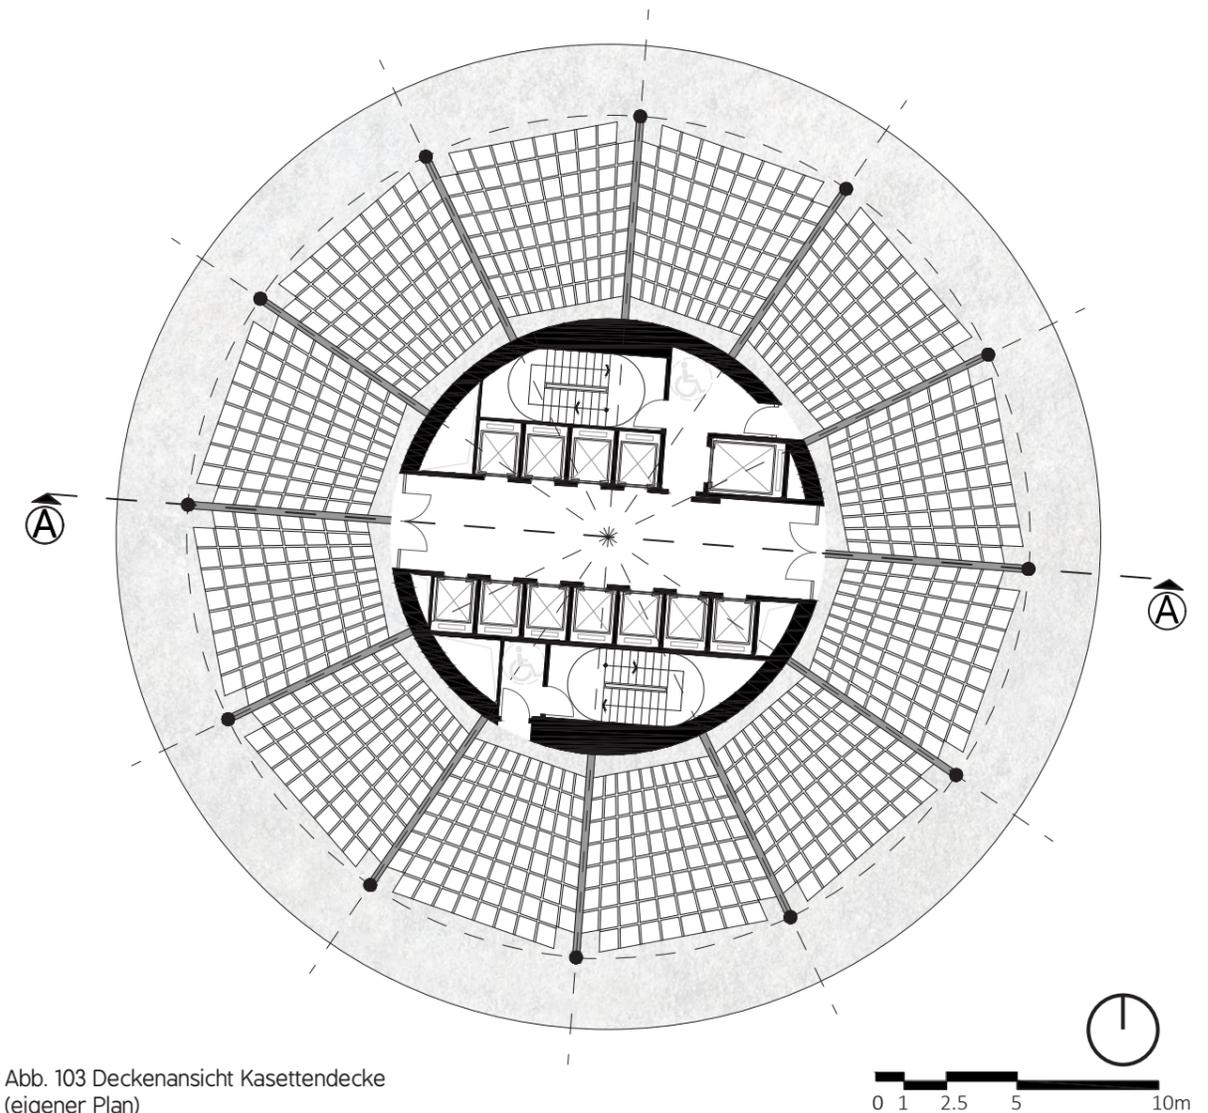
Deckenansicht Kasettendecke (eigener Plan)
